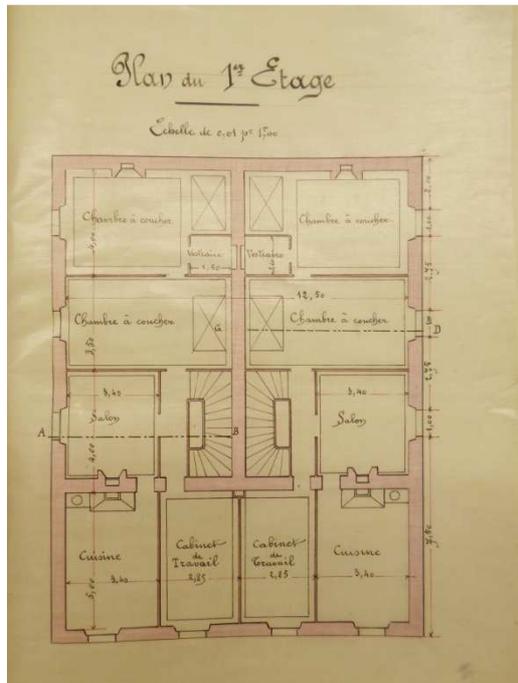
Projet de construction d'une maison d'école avec mairie, plan du 1^{er} étage, Angeli (conducteur des Ponts et Chaussées).
